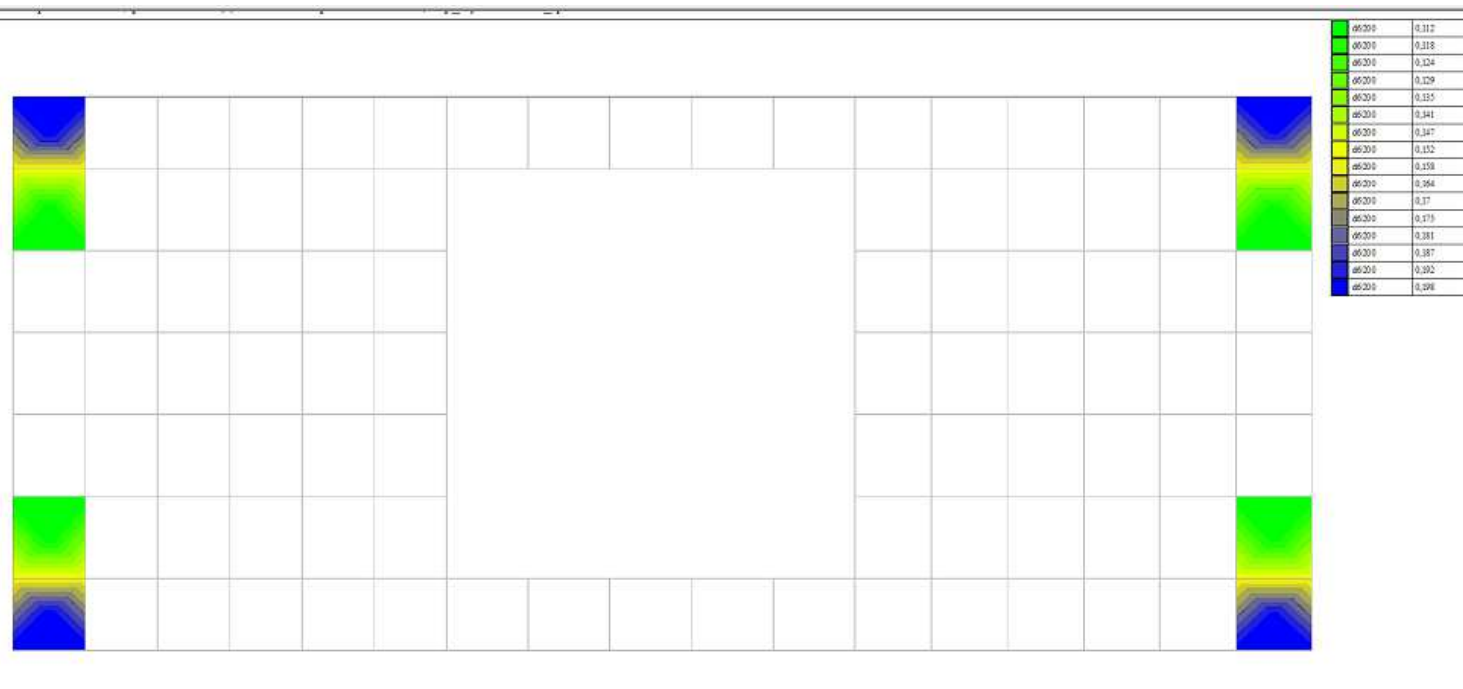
Схема верхнего армирования плиты по оси x
